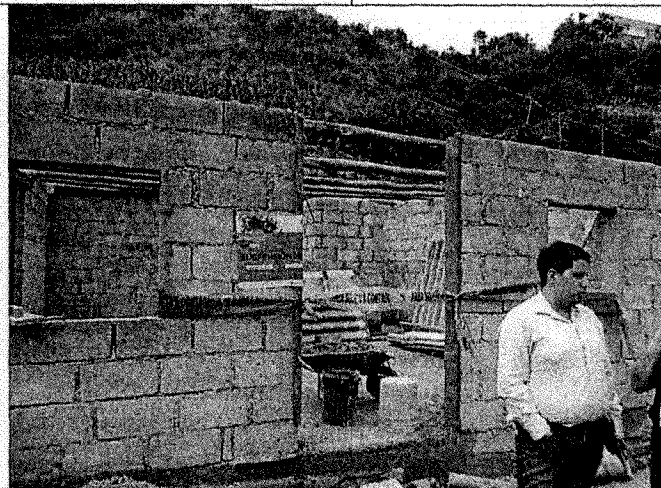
; Vista exterior de proceso constructivo en el predio N° 1212603, con vista del sello No. 131
